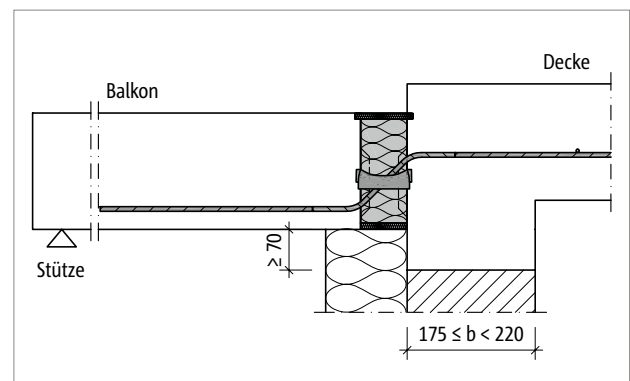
Schöck Isokorb® T Typ QL: Einbausituation mit kleinem Höhenversprung
